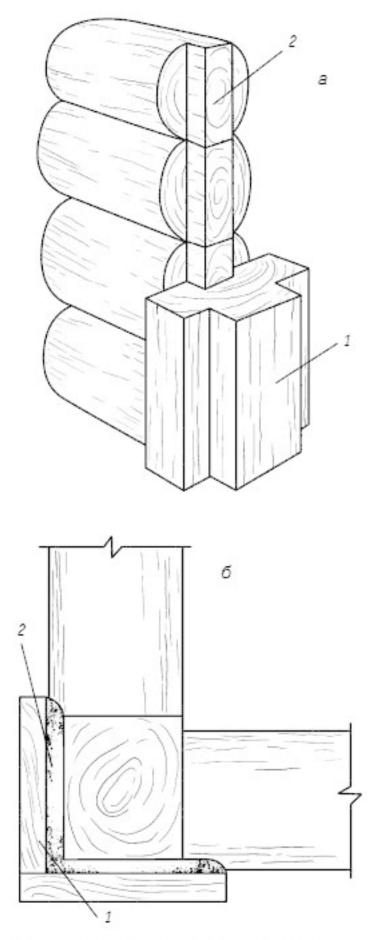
Установка и облицовка углов сруба: а — установка косяка: 1 — косяк; 2 — выступы на торцах бревен, входящих в паз косяка; б — облицовка угла сруба: 1 — угловая пилястра; 2 — слой пакли
